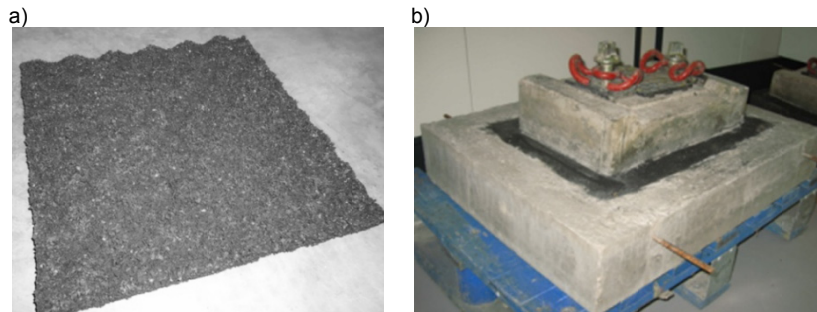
a) Vista de la cara ahuecada de la manta elastomérica y b) Vista del bloque elastomérico aislado a utilizar en superestructuras con losa de hormigón.
